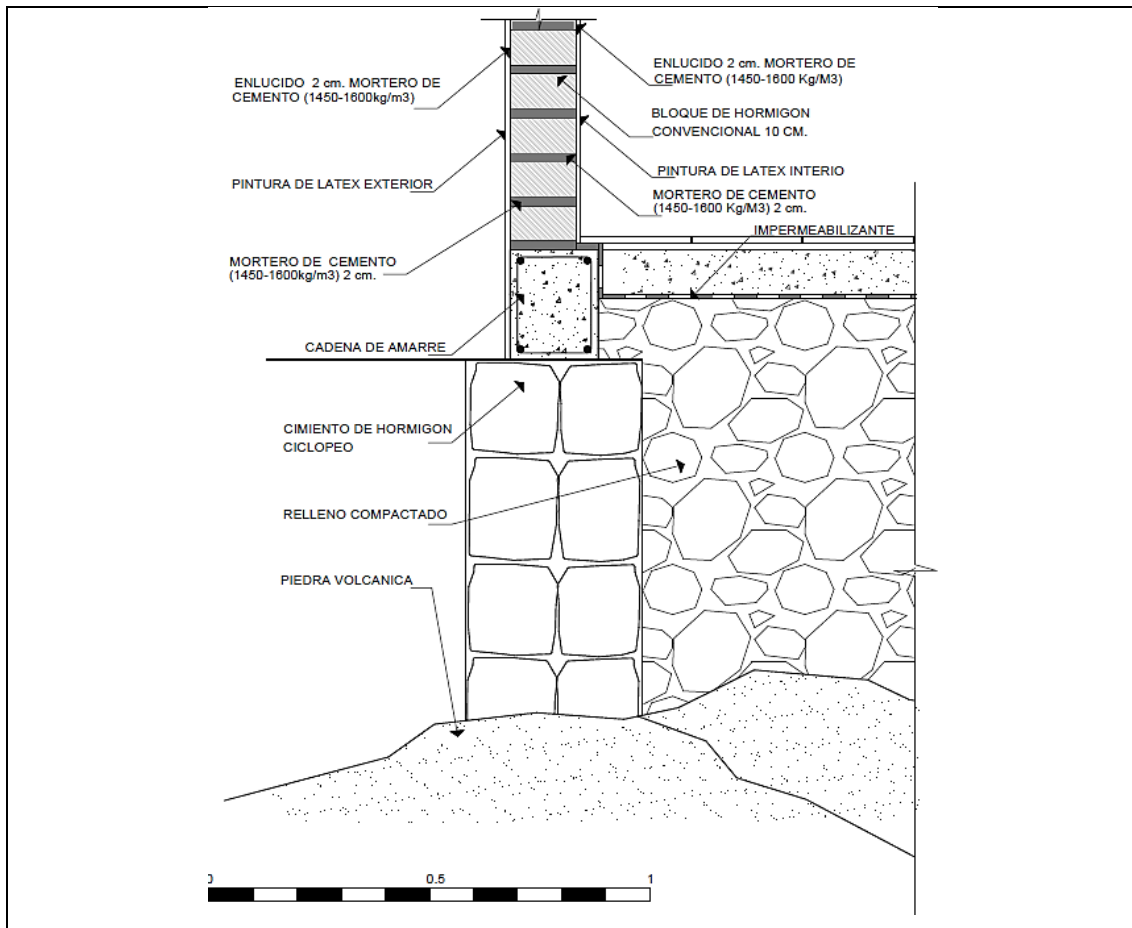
Detalle del sistema constructivo de la pared y de la cubierta de la vivienda 2. Elaboración propia 2017
